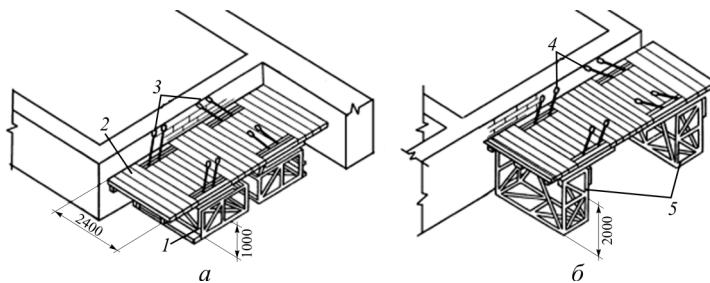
Универсальные пакетные самоустанавливающиеся подмости: *а* – в нижнем положении (кладка второго яруса); *б* – в верхнем положении (кладка третьего яруса); 1, 5 – прямоугольные опоры; 2 – рабочий настил; 3, 4 – стропы для перевода опор в вертикальное и горизонтальное положение (рисунок взят из ТТК «Кирпичная кладка внутренних стен»)
